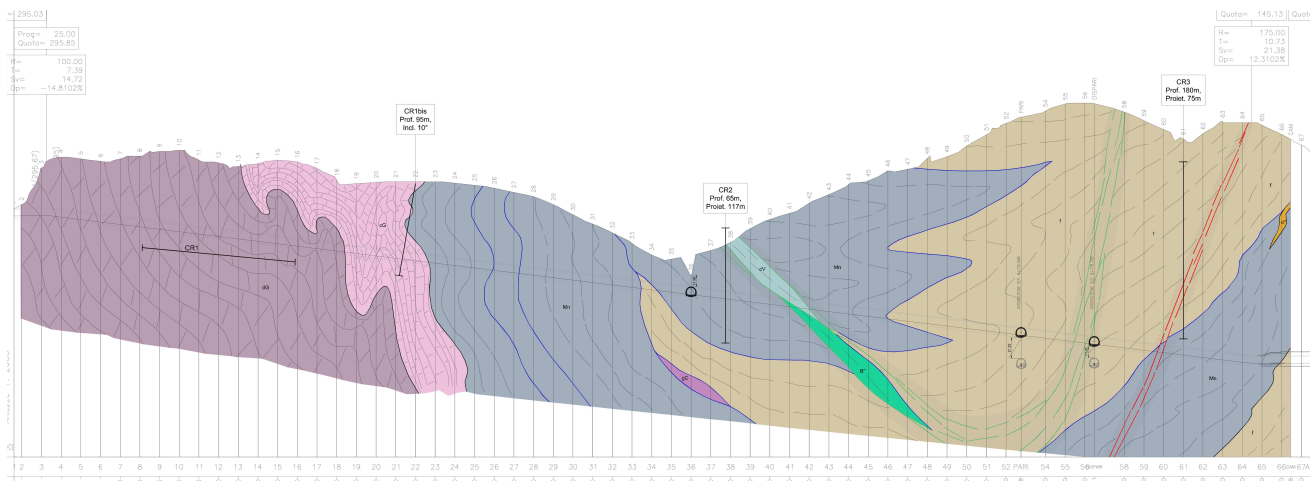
Profilo geologico longitudinale della soluzione 4 – Progetto Esecutivo con sovrappasso delle gallerie di linea, della Finestra Cravasco
